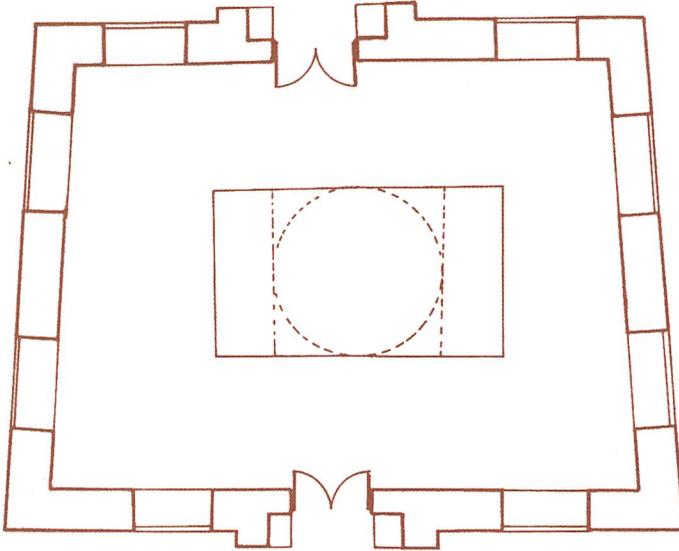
المسقط الأفقي لقبة وضريح الجيشى بدمنهور
